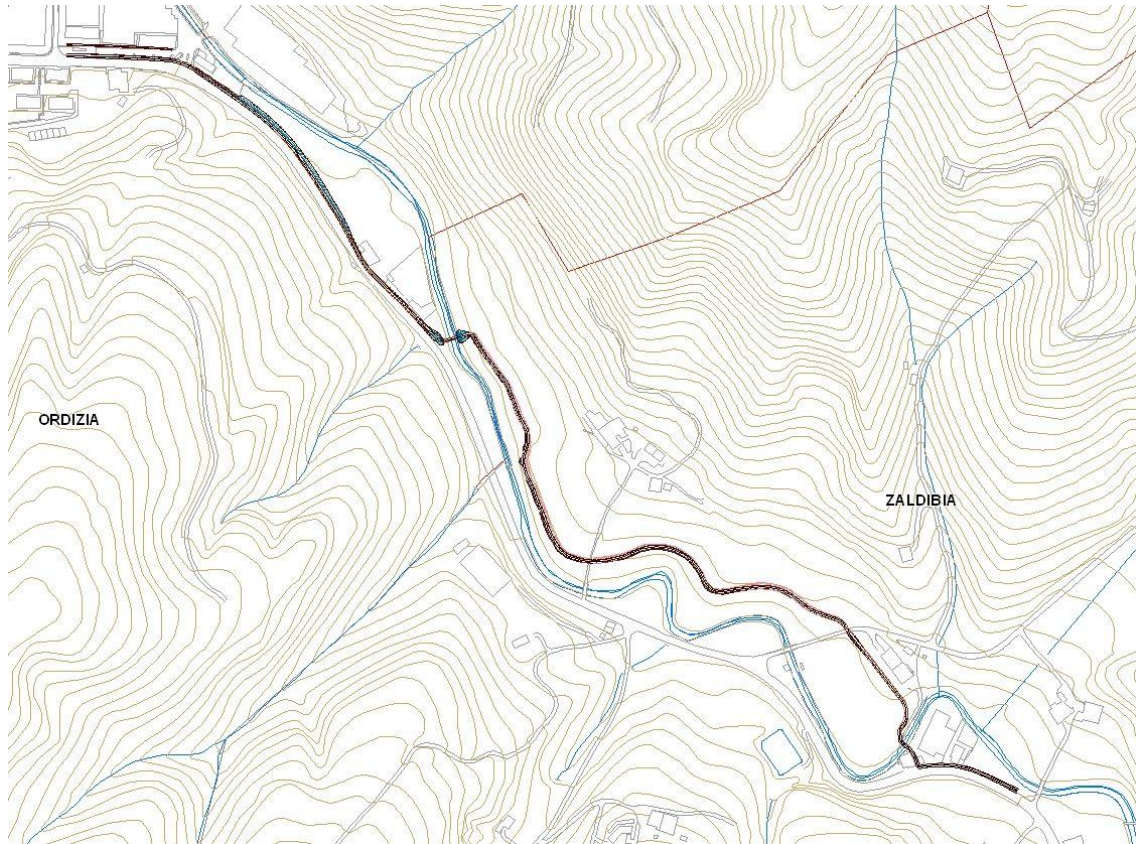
Trazado propuesto por la alternativa 1 correspondiente al tramo 1.
